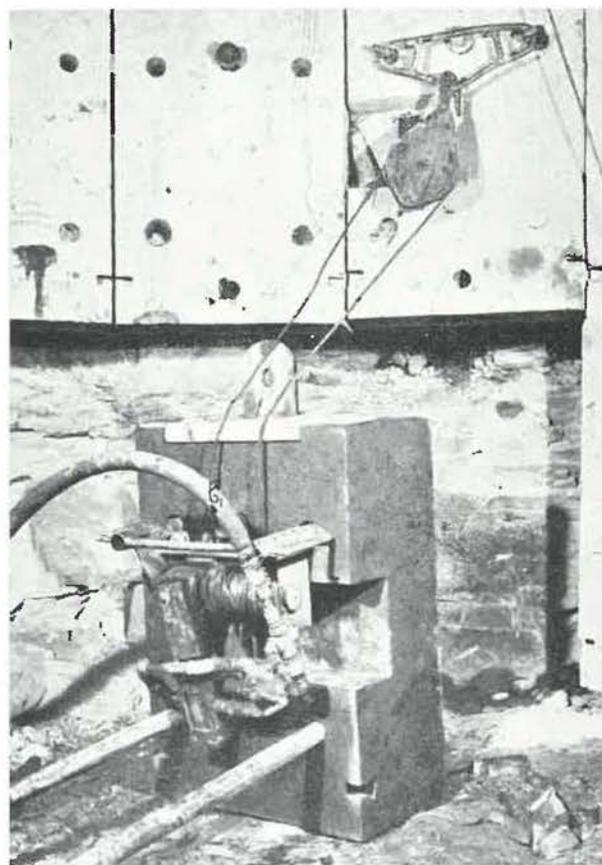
Treuil Hausherr pour la mise en place des claveaux.
